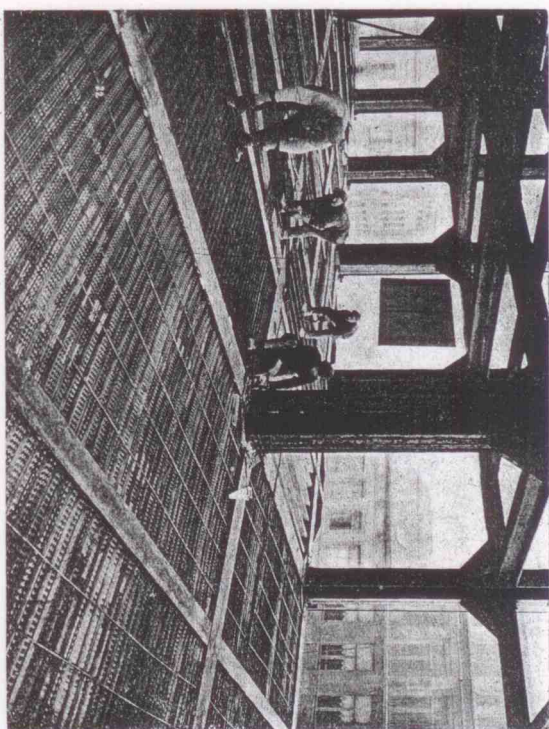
Emprego na construção das lajes dum grande edificio de 26 andares em Antuerpia.
